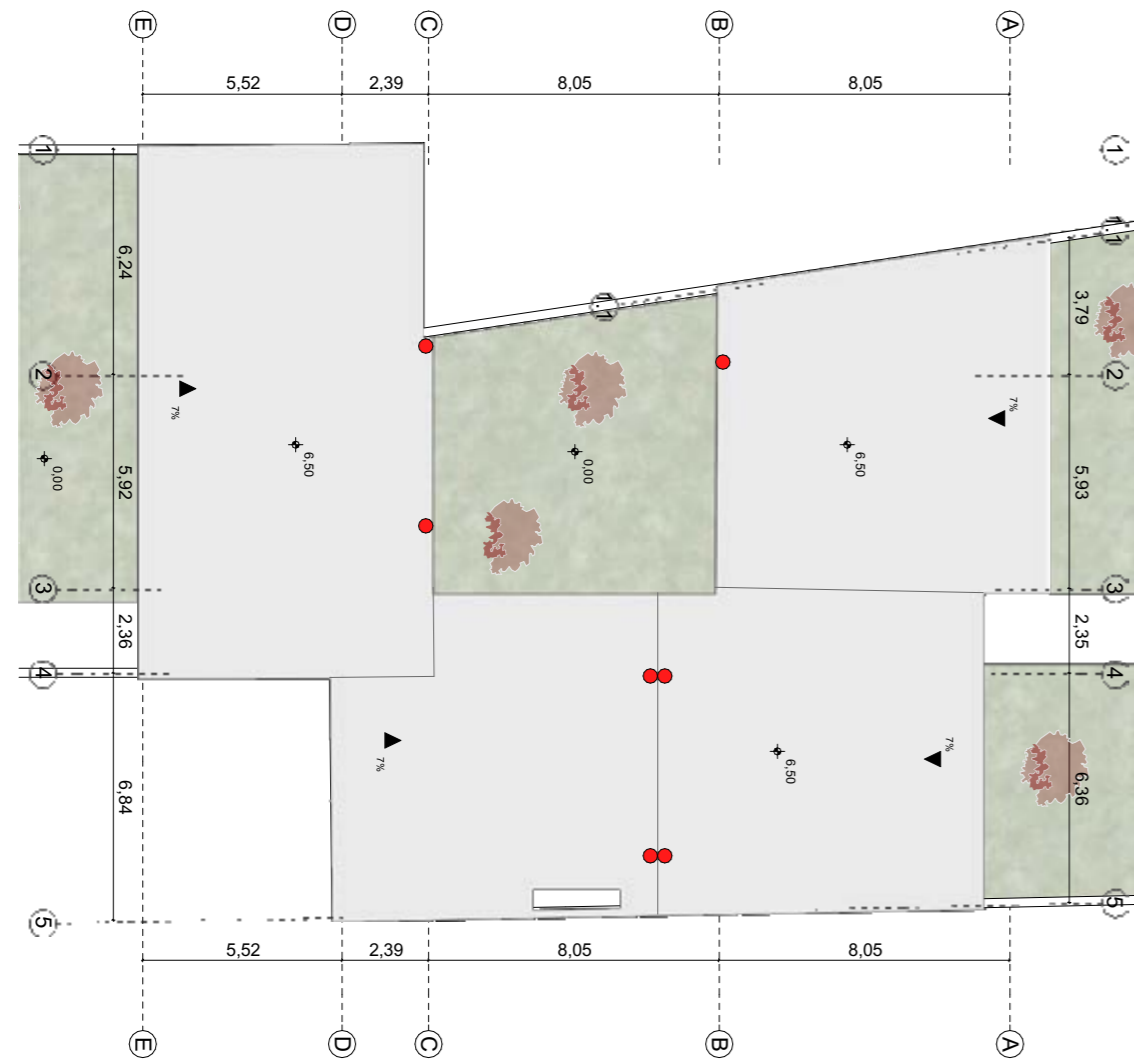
Planta de cubierta del proyecto - Bloque 2. Nota. Elaboración propia
